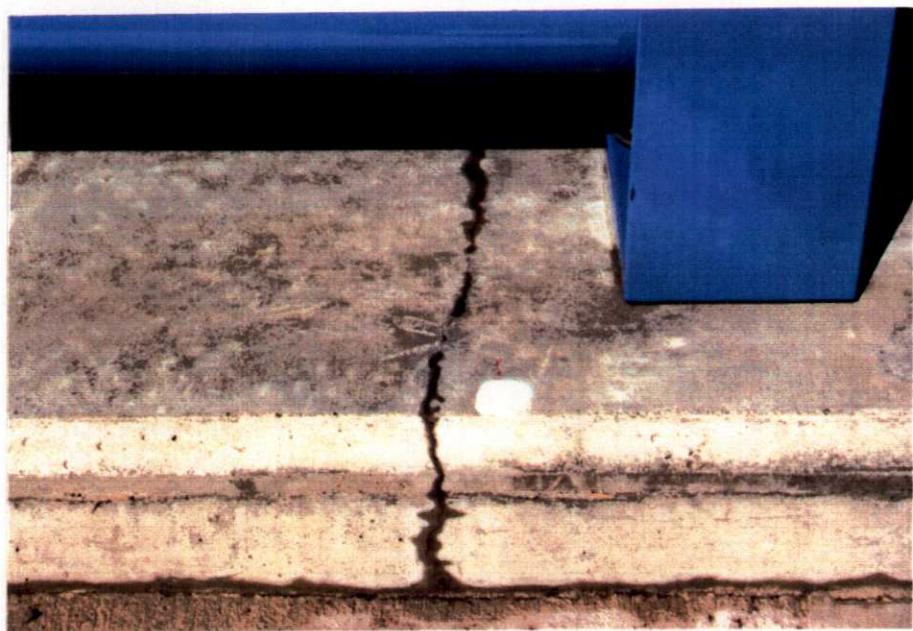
2 施工時ひびわれの例（地覆）
